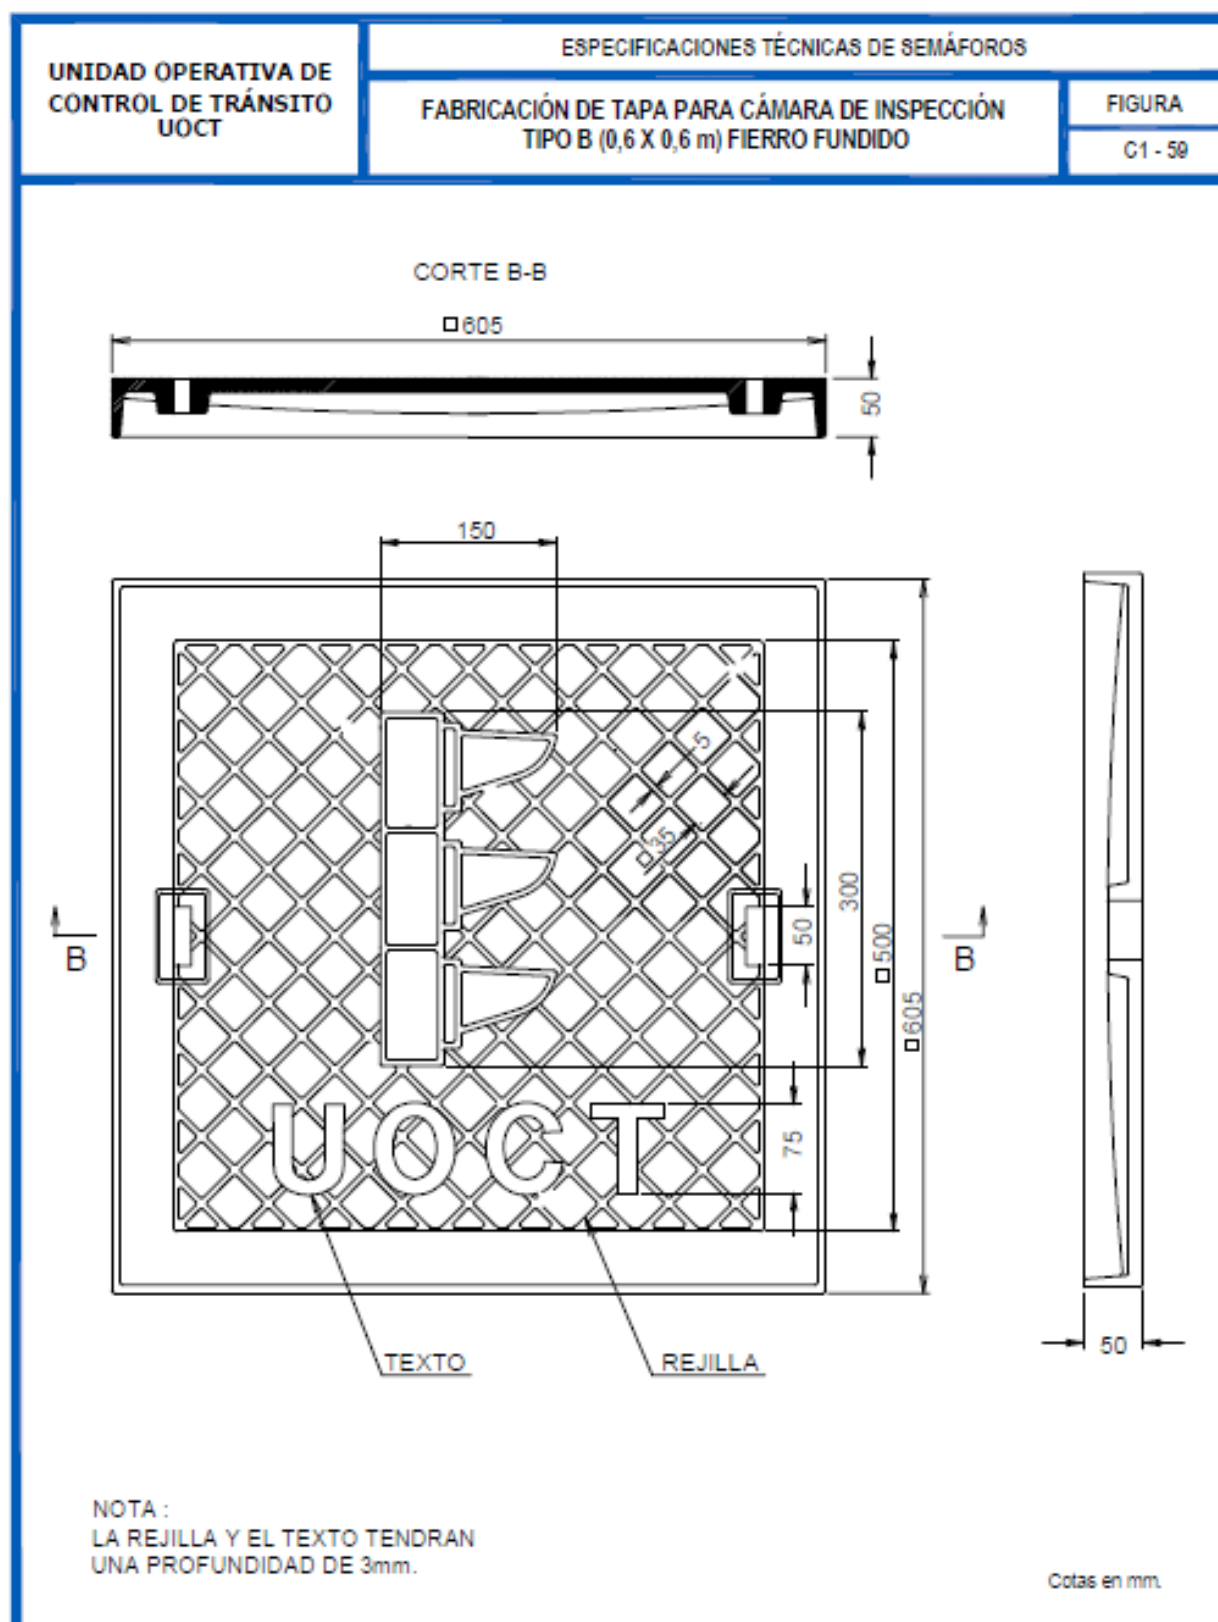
59 Fabricación de Tapa para Cámara de Inspección Tipo B (0,6x0,6m) Fierro Fundido
